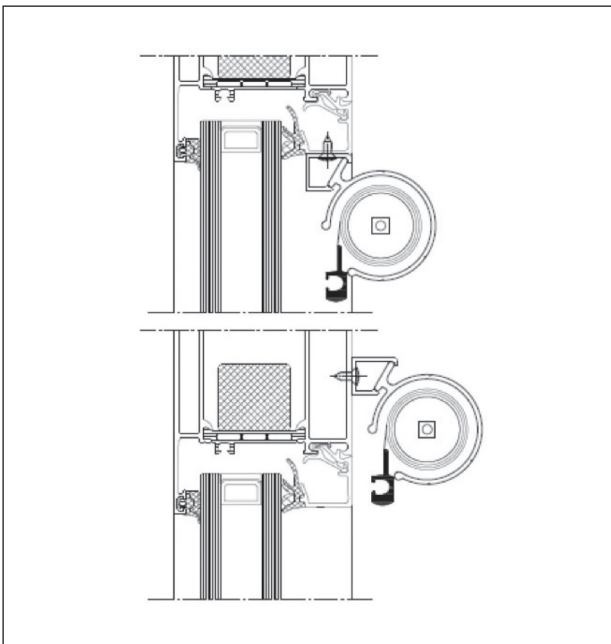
Glasfalzmontage (Einbau mit minimalem Platzbedarf zwischen den Glasleisten) und Rahmenmontage (Einbau auf dem Fensterrahmen mit runder Kasette) (Ansicht beispielhaft)
